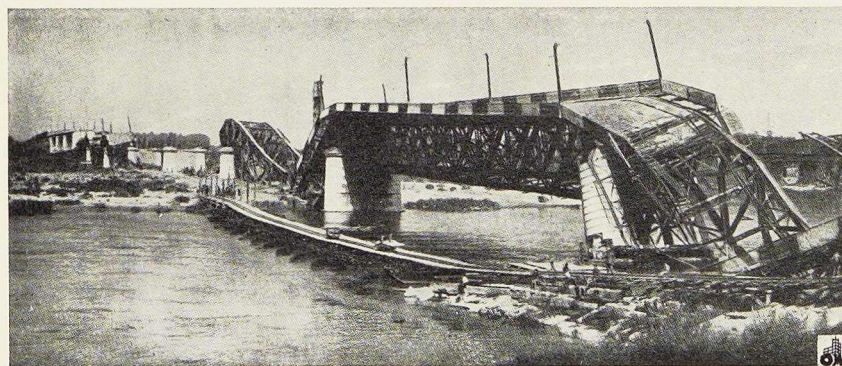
Vue du pont-route sur le Pô à Piacenza, après sa destruction en 1944.
